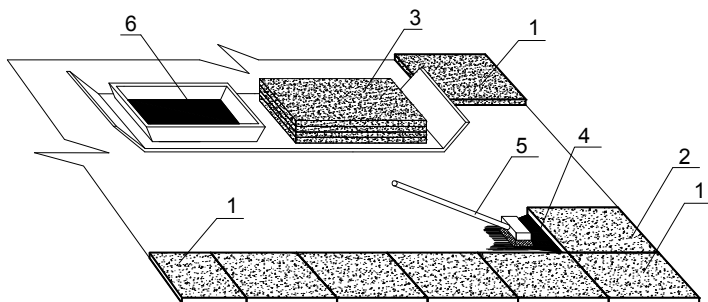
Технологическая схема укладки плитного утеплителя на мастике:
